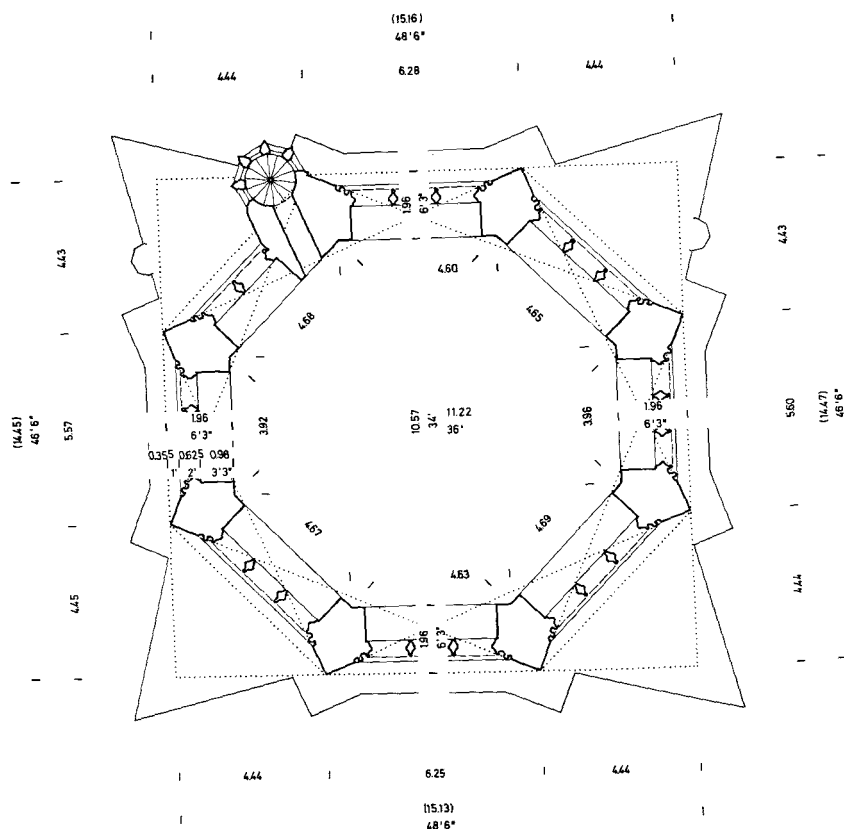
Freiburg Münsterturm, Grundriß des 2. Achtortgeschosses.
